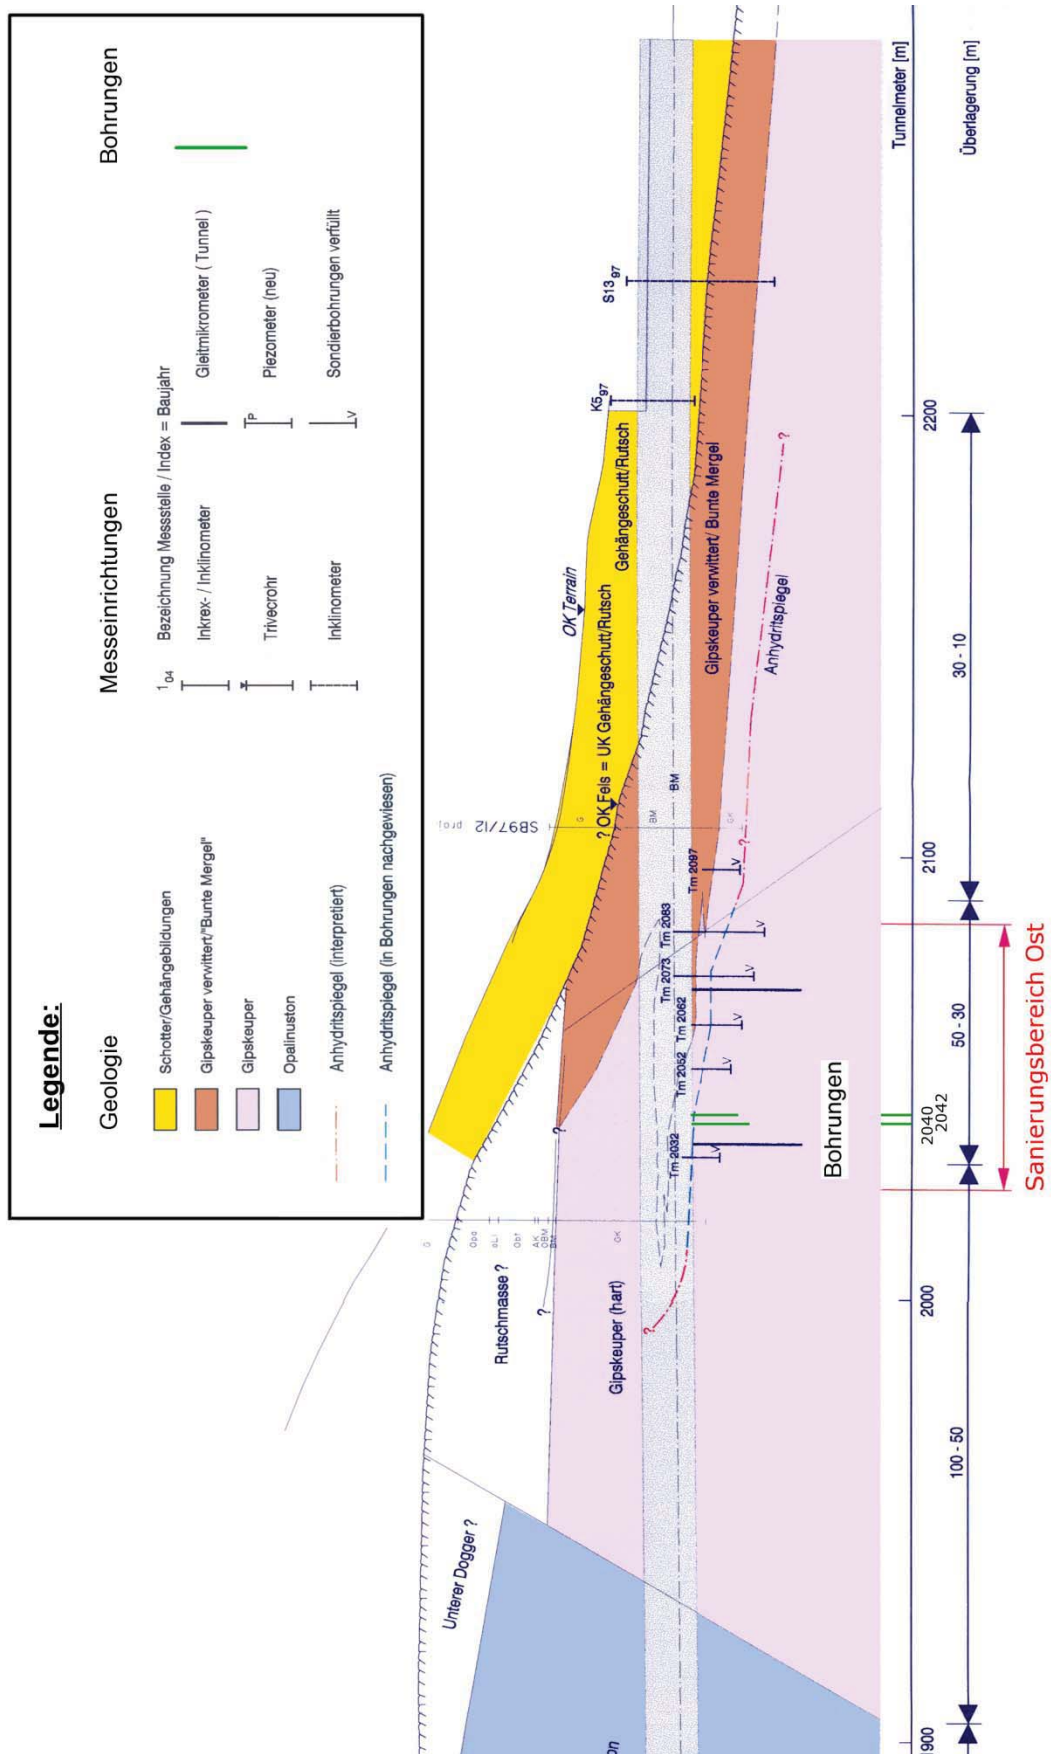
Lage der Bohrungen im Sanierungsbereich Ost des Chienbergtunnels (Auszug aus IG Aegerter & Bosshardt / Gruner AG Plan Nr. 5535/9926 Situation, Längenprofil, Stand Nov. 2005, modifiziert)
